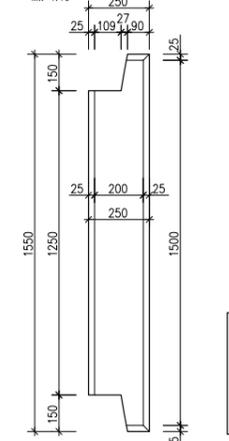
### DETAIL TUR "Vergußbrett" DETAIL DOOR "Overmoulding board" M 1:10
